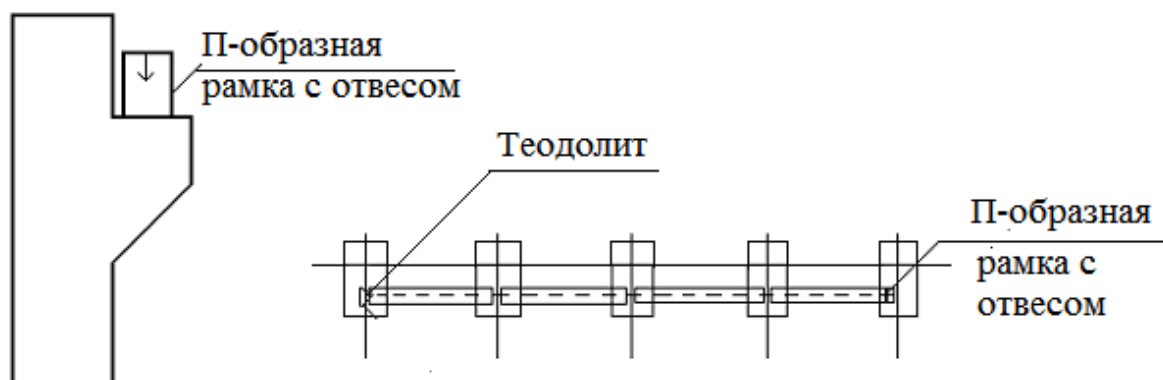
Выверка подкрановых балок по теодолиту и рамке
